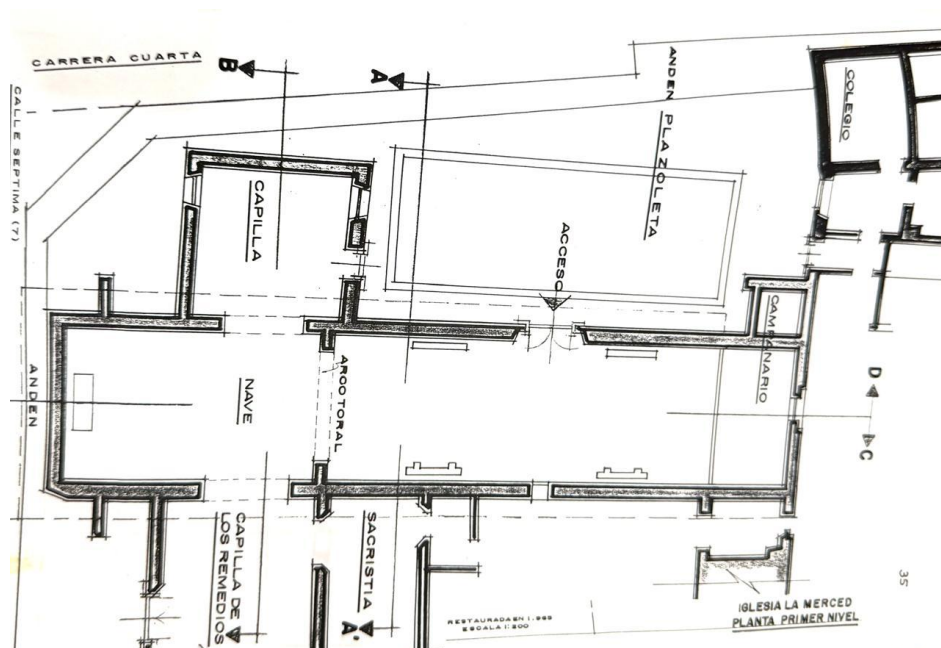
Plano en planta iglesia la merced despues de la primera restauración. Fuente: (Sinisterra O'byrne, 1974)
